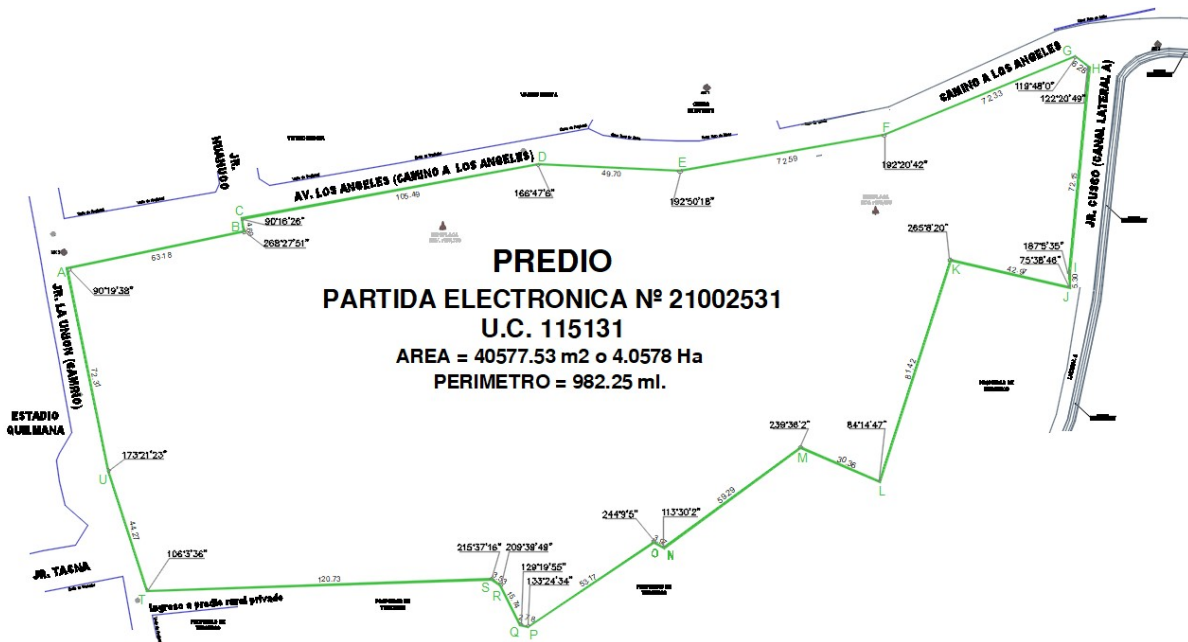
Plano Perimétrico (Fuente Propia).
